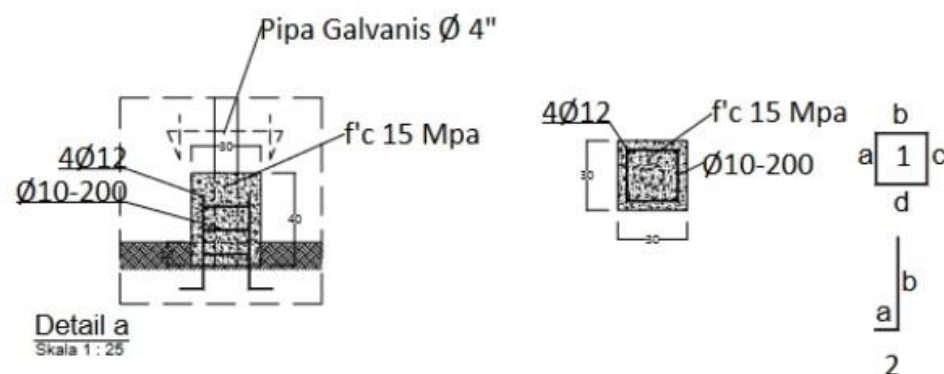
DETAIL RENCANA STRUKTUR KOLAM ANEROBIK 2
